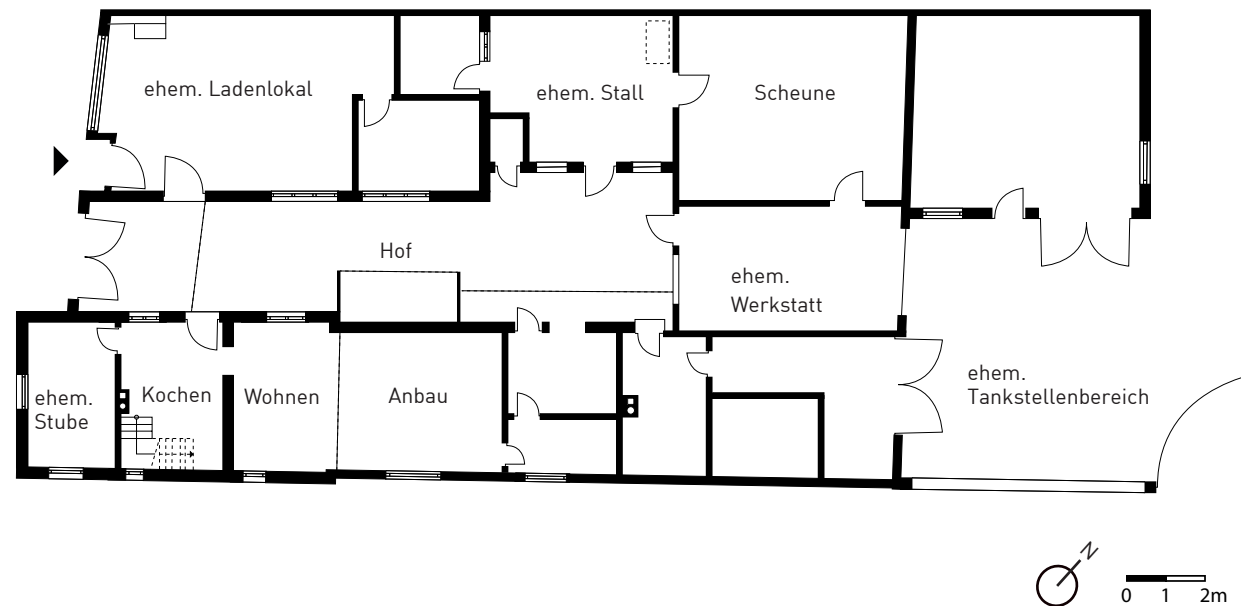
Erdgeschoss Grundriss, 2021.
